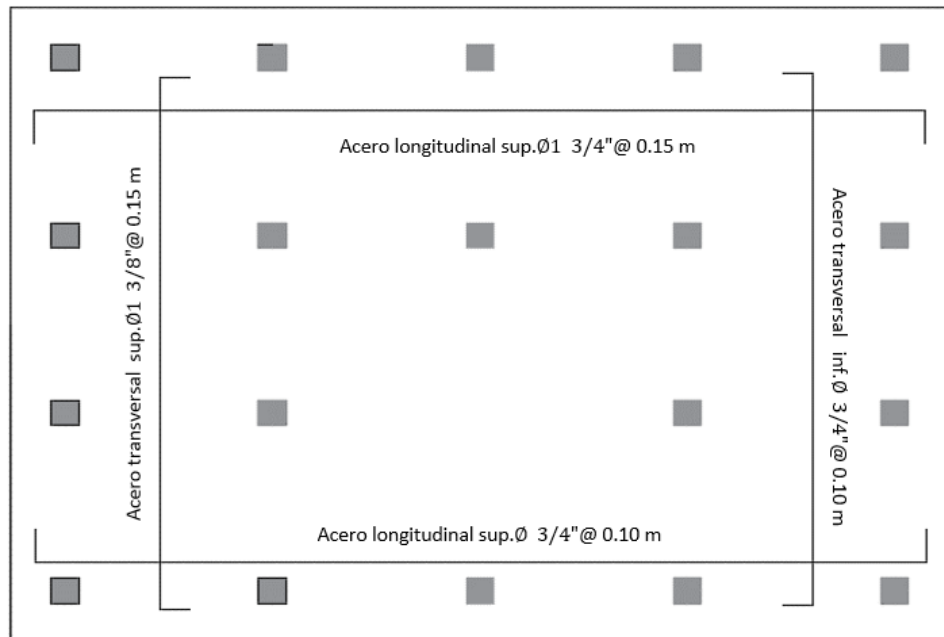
35. Distribución de acero en losa de cimentación para edificio de 15 pisos
